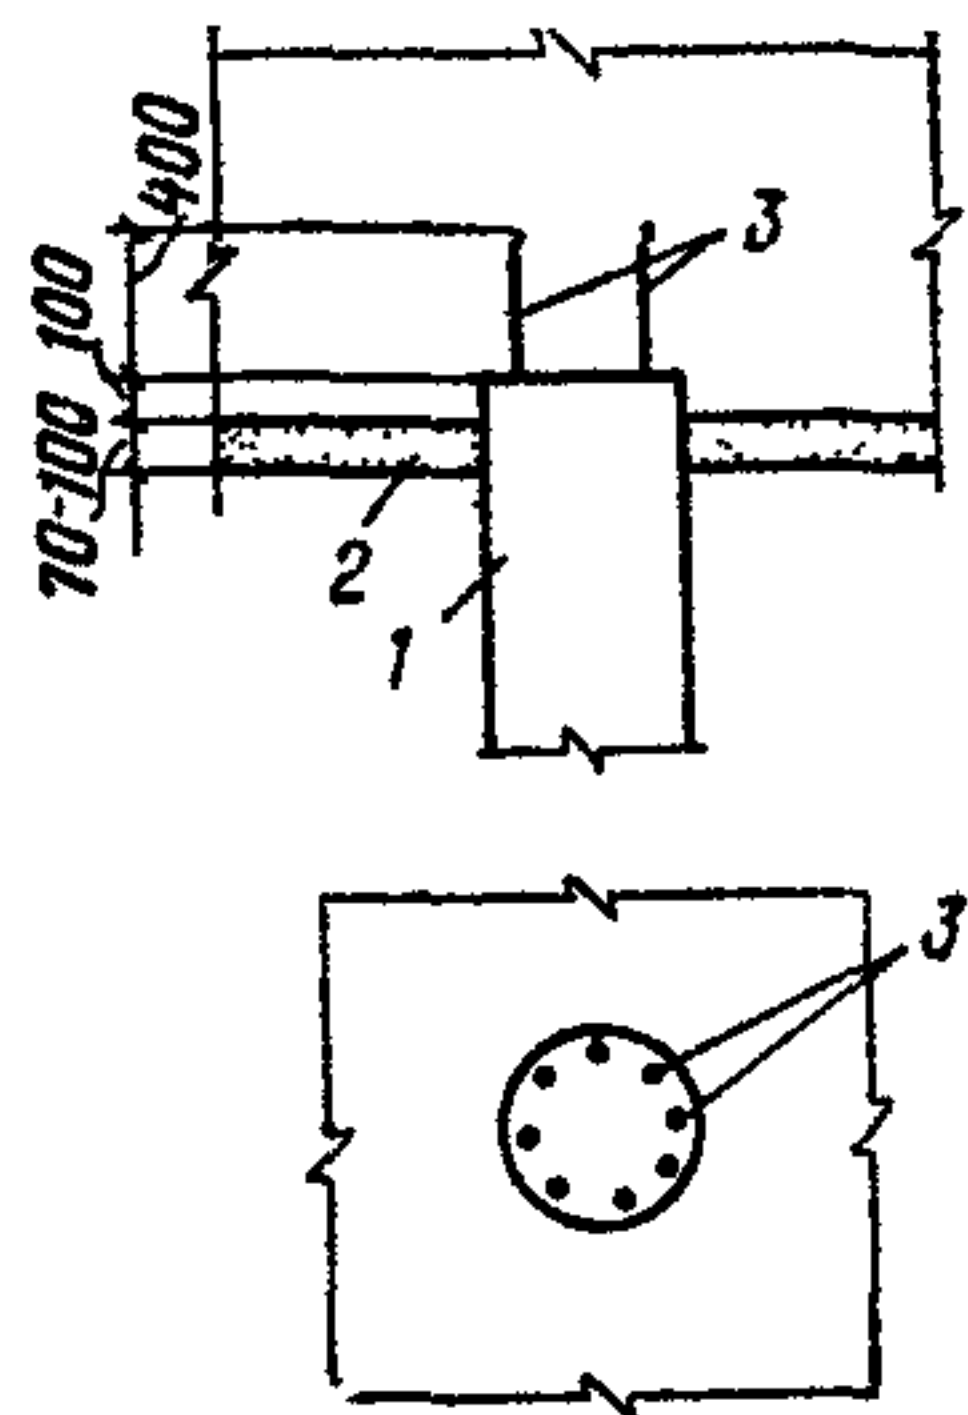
Пример конструктивного решения сопряжения буронабивной сваи, работающей на нормальную сжимающую нагрузку, не выходящую за пределы ядра сечения свай, с монолитным железобетонным ростверком
